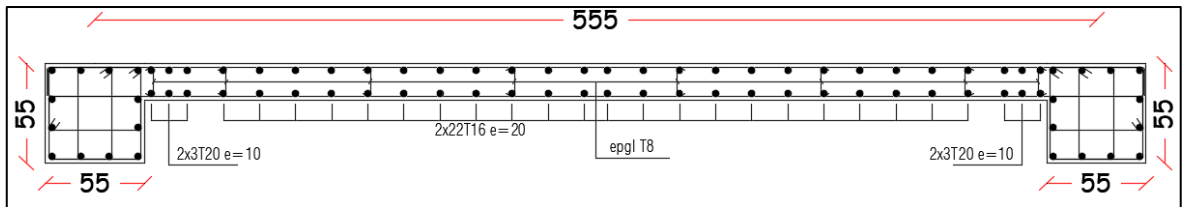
Exemple de ferrailage du voile RDC (L= 5,00 m)
